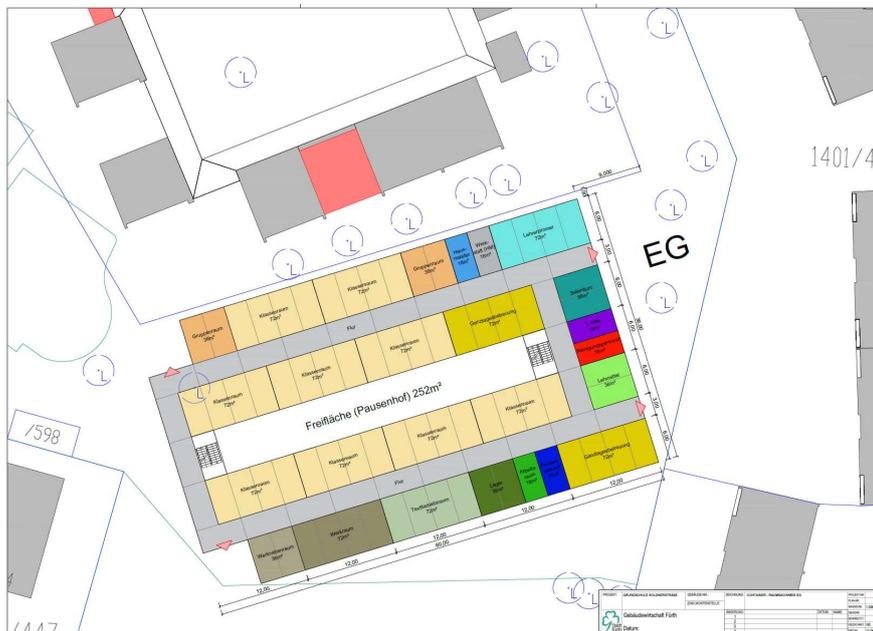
Grundriss Container Soldnerstr. 60
